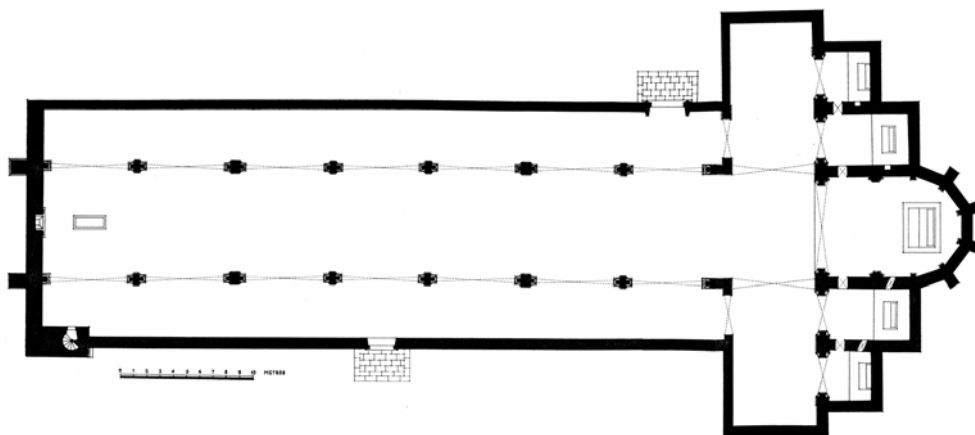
Santa Clara de Santarém, igreja, planta (DGEMN).
